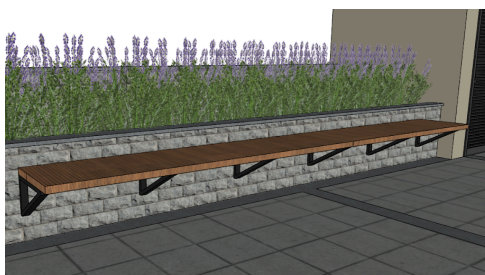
Referência do banco de madeira fixados com suportes de ferro preto nas muretas
